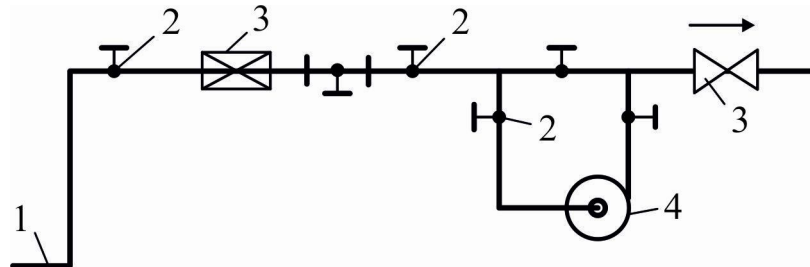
Схема внутрішнього водопроводу без водонапірного резервуара і насоса, що підкачує (з нижнім розведенням):
